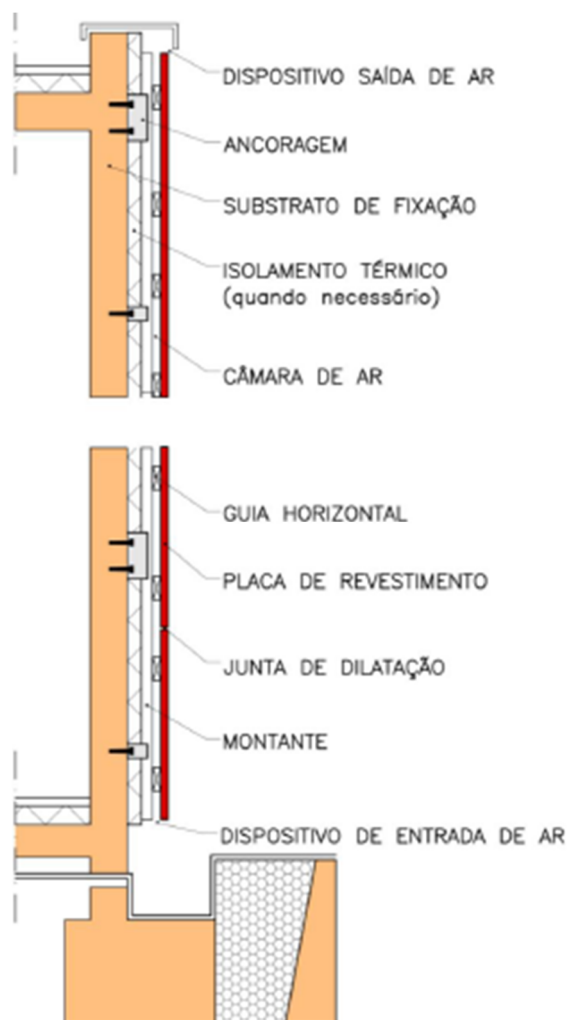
Componentes de um Sistema de Fachada Ventilada.
